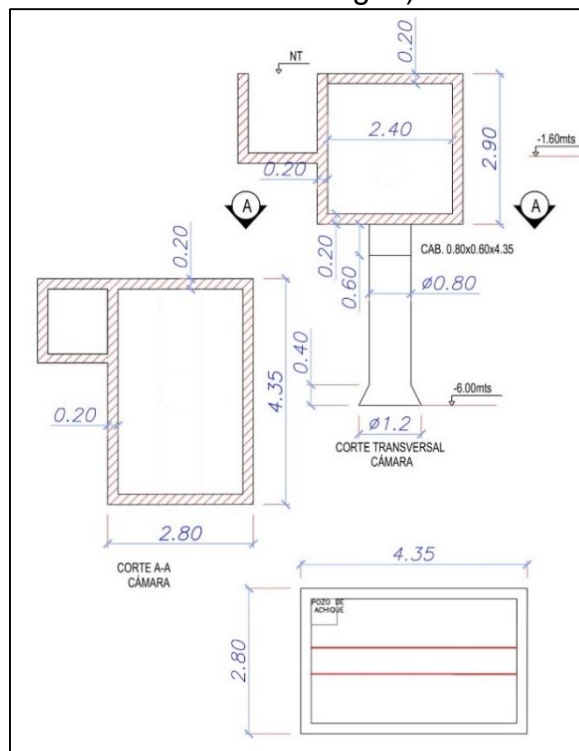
Detalle galería 3. (PLANO N° 31)
